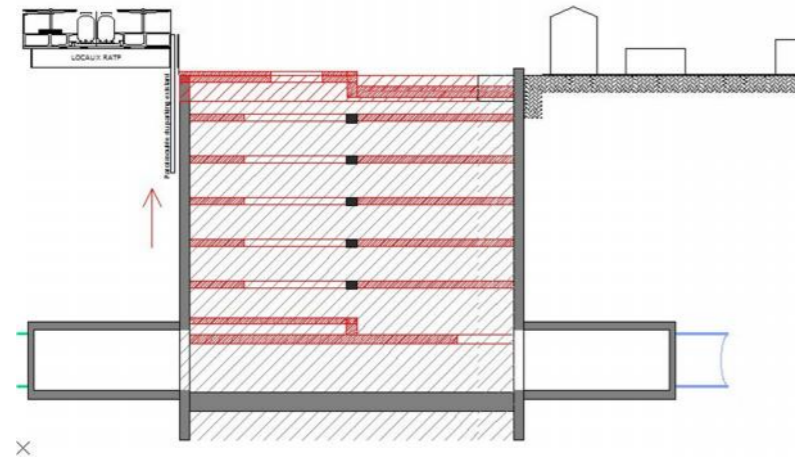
Etape 5 – Emprise de chantier et finition des travaux de GC
